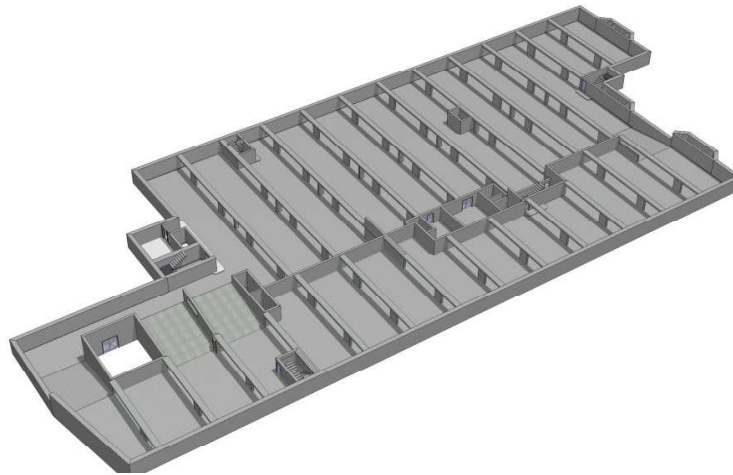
BIM-Modell einer Parkhaus-Geschossebene.
